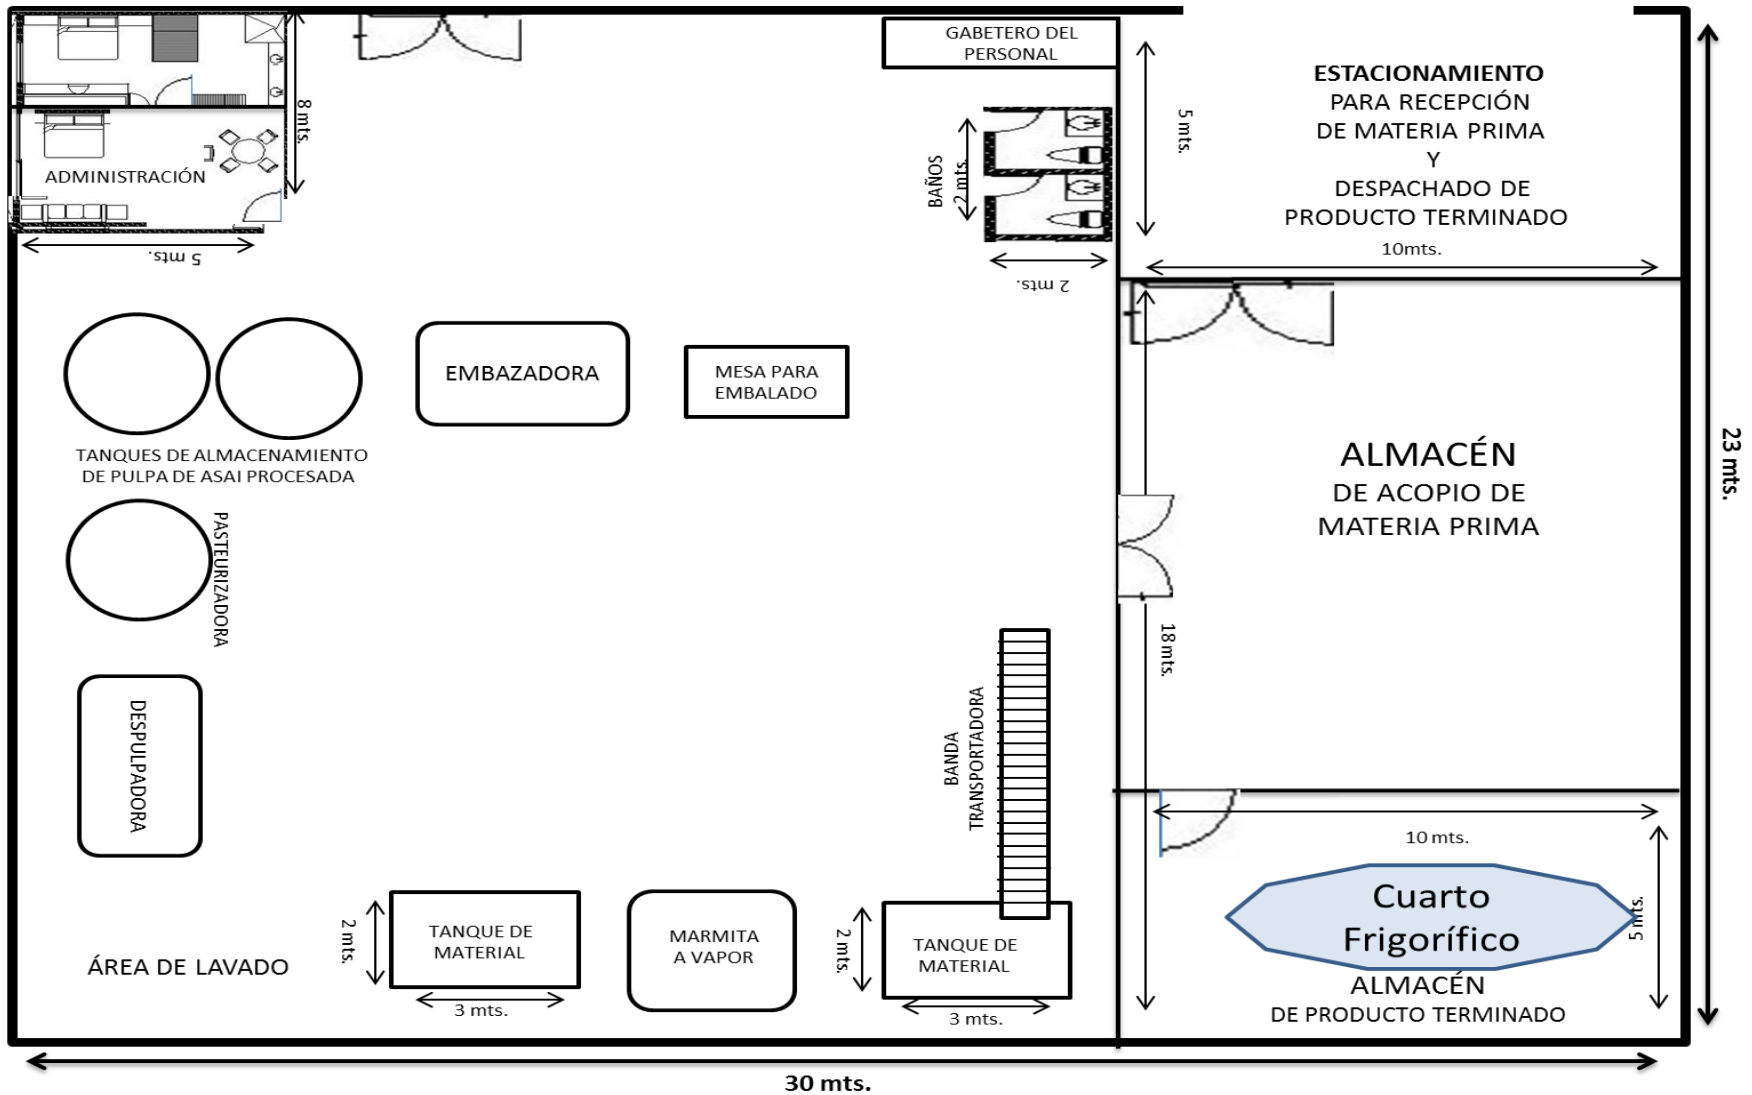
Plano de instalación y distribución de la planta de AMAZON-FRUTS
